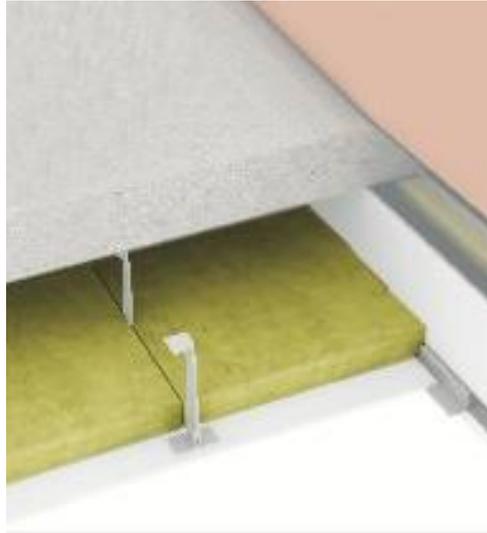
Sistema de aislamiento térmico oculto por falso techo de placas de yeso laminado. (Fuente: generador de precios de cype)
